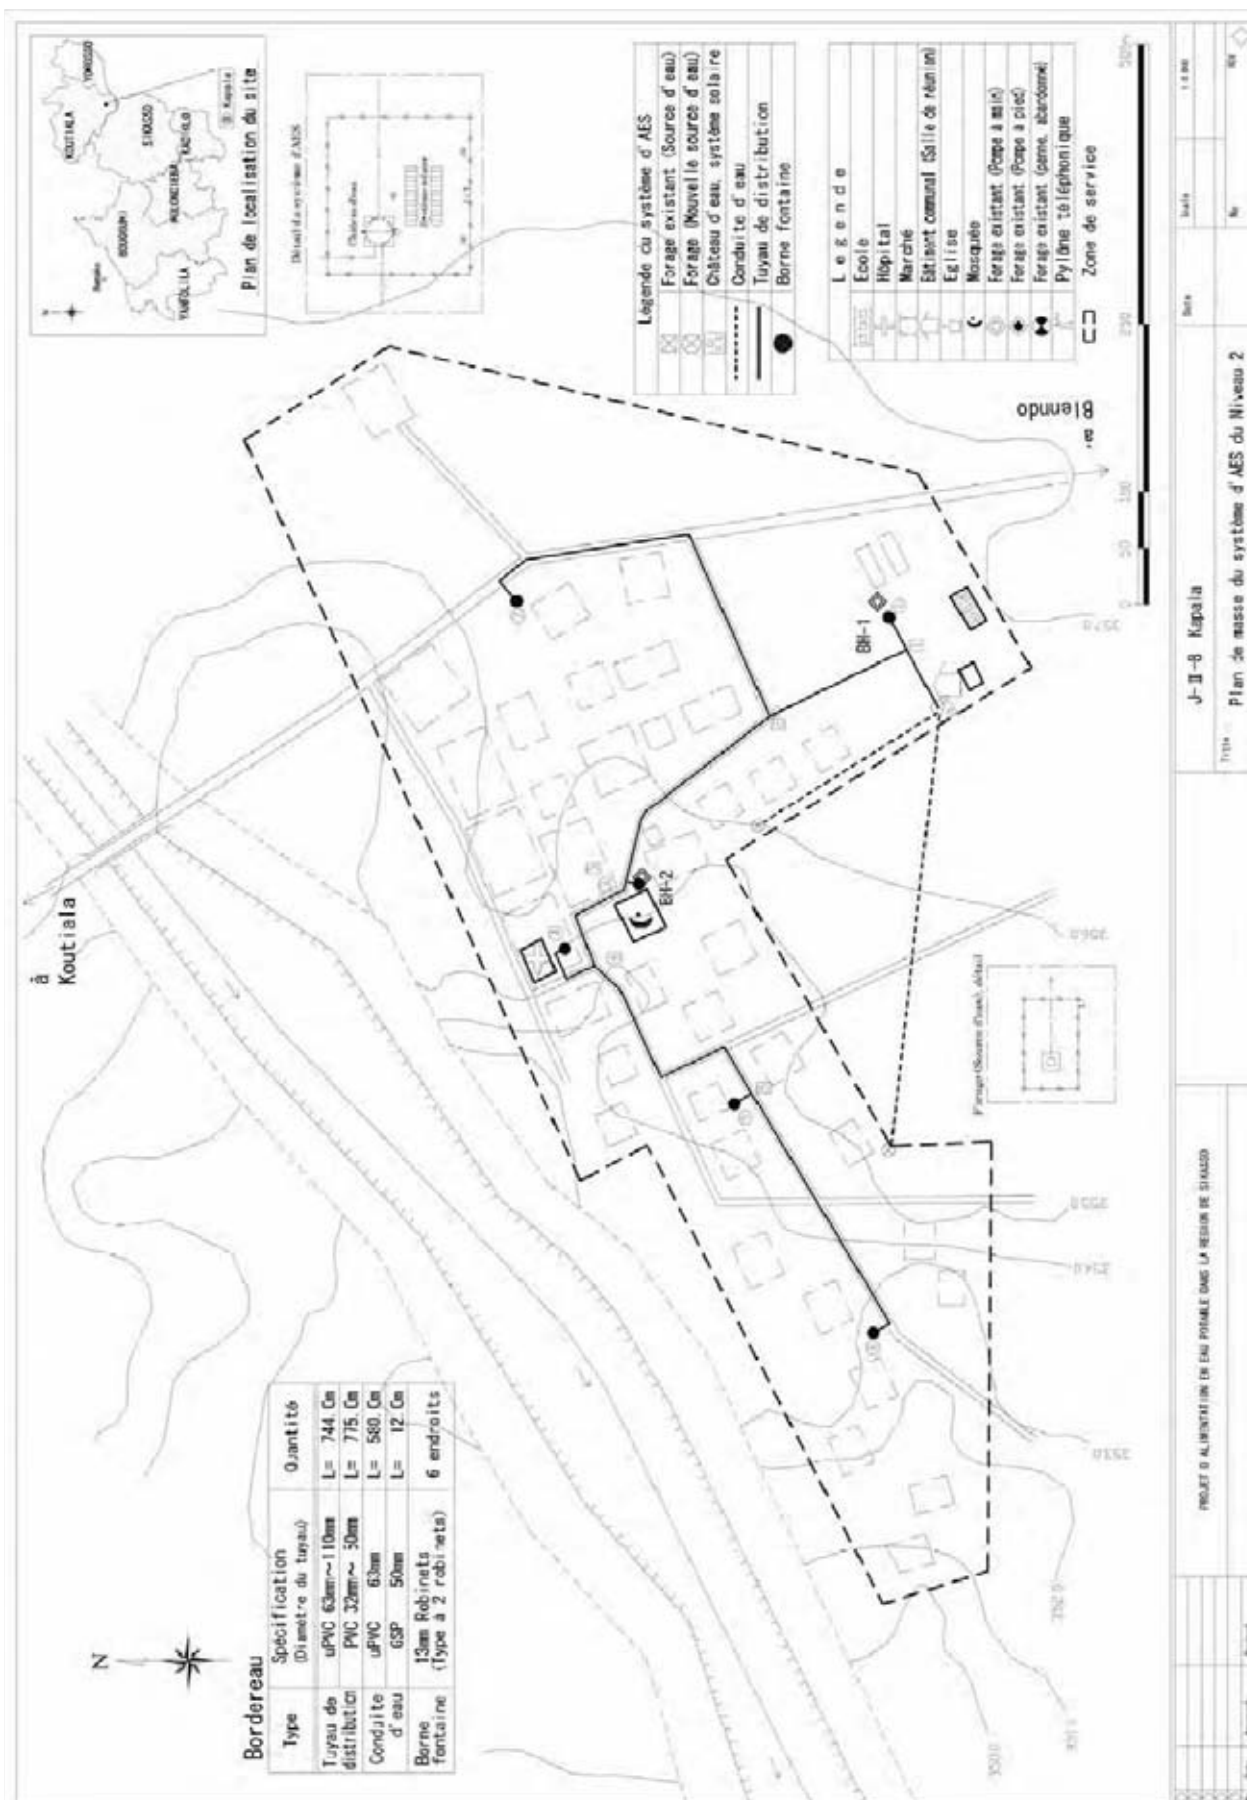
Plan de masse du système d'AES du Niveau 2 (J-11-8 Kapala)
